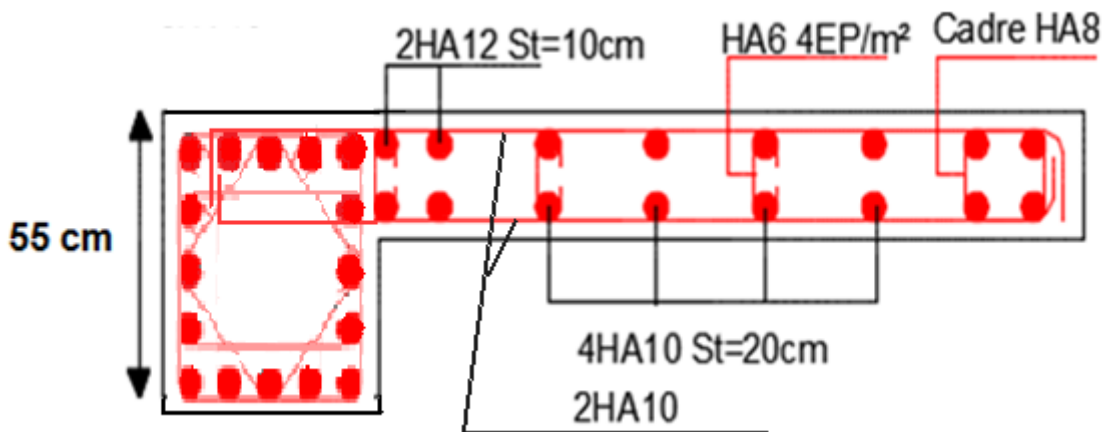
Schéma de ferrailage du voile Vy1 (RDC+1<sup>er</sup> étage).
